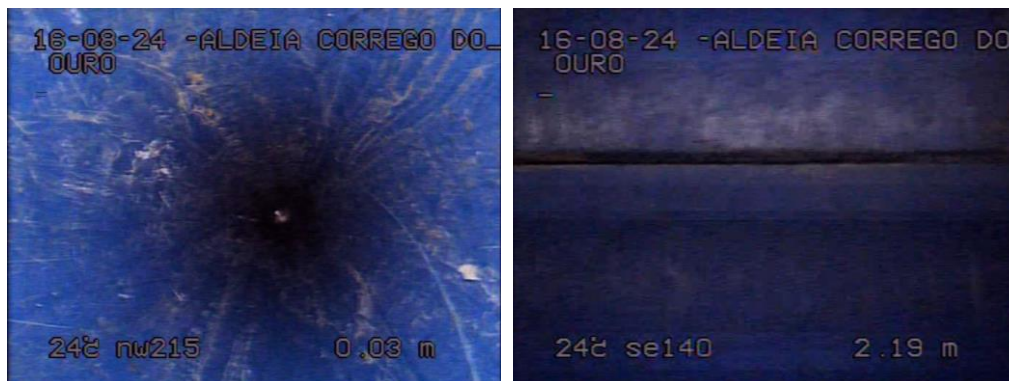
e 7 : – Equipe técnica realizando o posicionamento da câmera na boca do poço e a subsequente perfilagem ótica.
